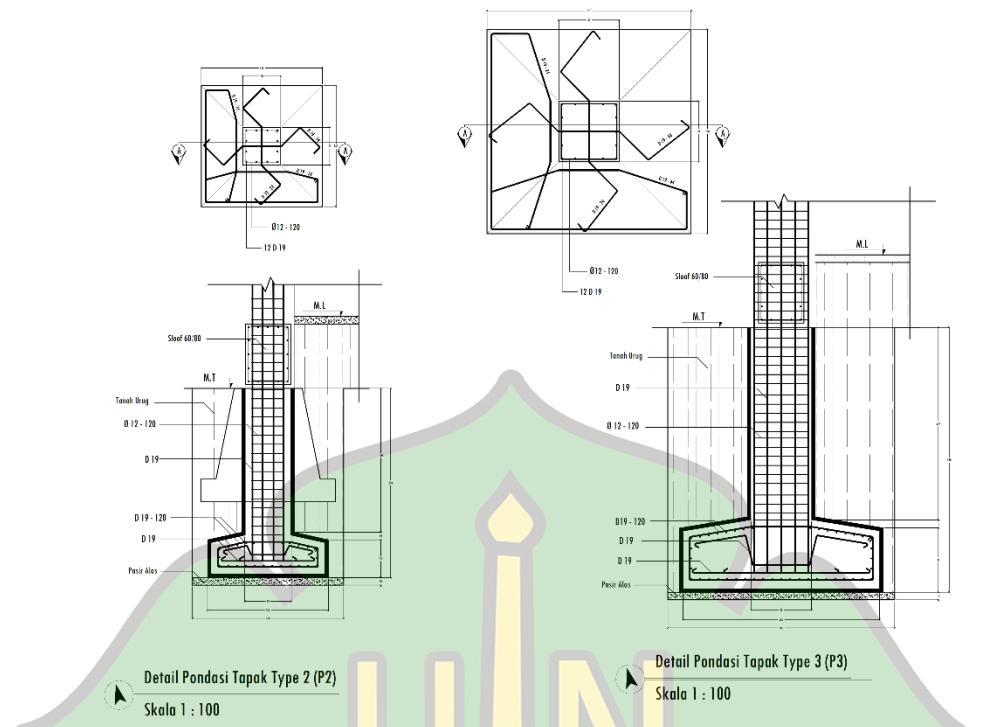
Rencana Pondasi Exhibition Hall
